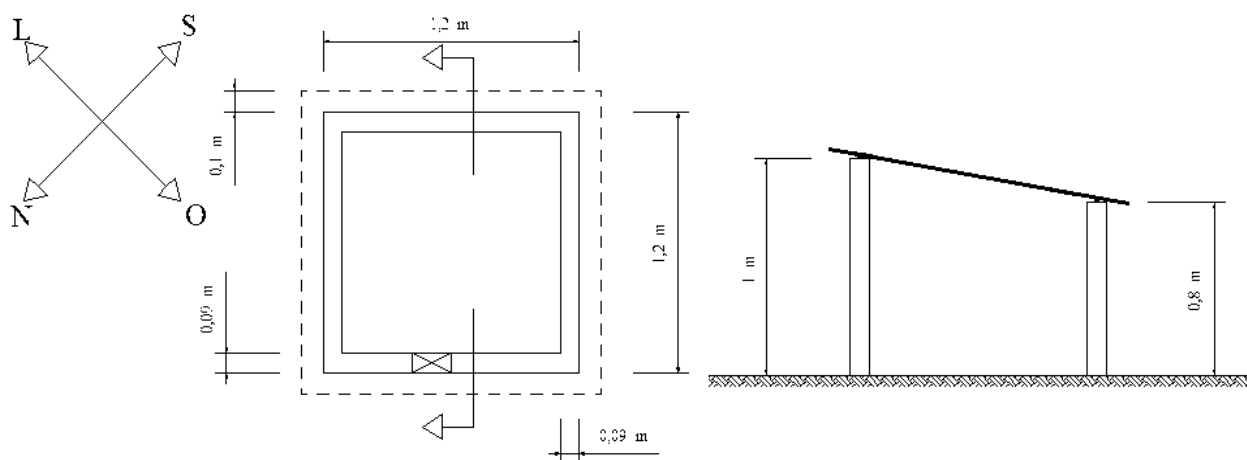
Planta Baixa e corte de uma das células-teste em estudo
